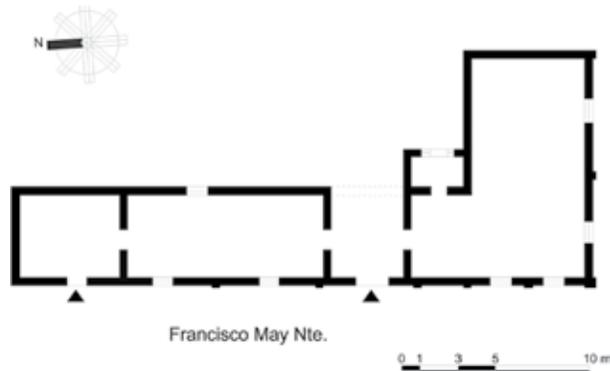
Planta de la Biblioteca Pública. Dibujo de David Pérez Fernández.
